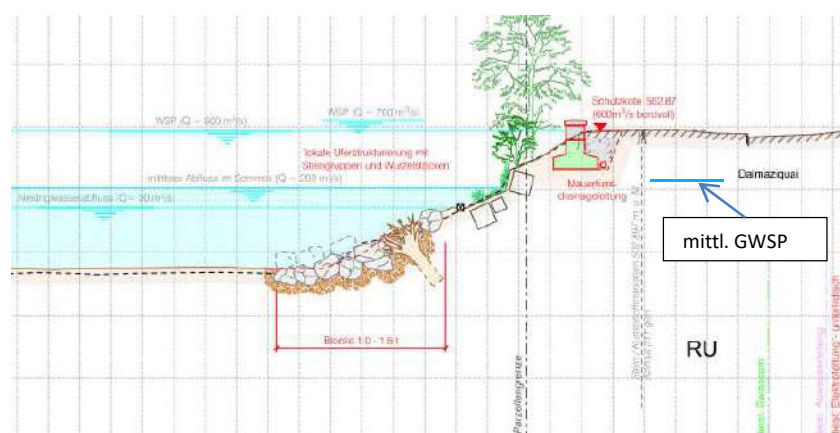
Ausschnitt aus dem Querprofil km 28.070 im Bereich Dalmaziquai, Wasserbauplan Beilage B.3.2
